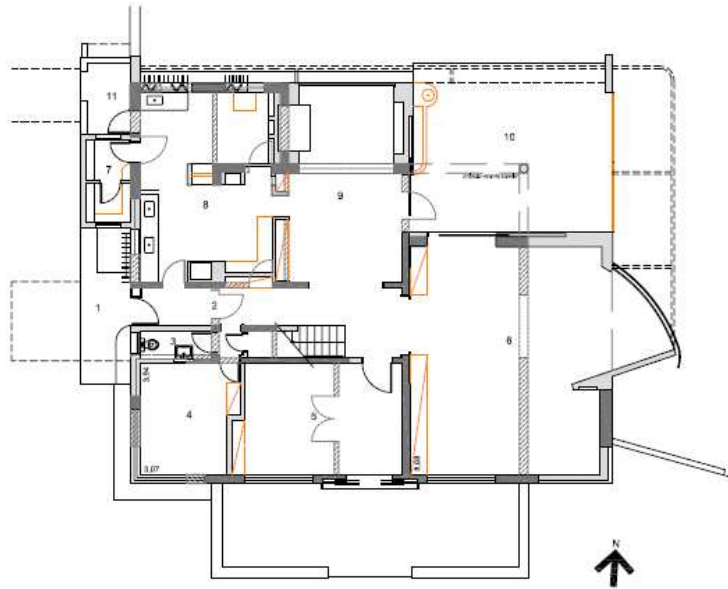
Planta pavimento térreo. Em cinza escuro: remanescentes de 1928; Hachurado: demolido em 1935; Cinza claro: construído em 1935; Laranja: alterado em 2006. (Desenhado pela autora)
